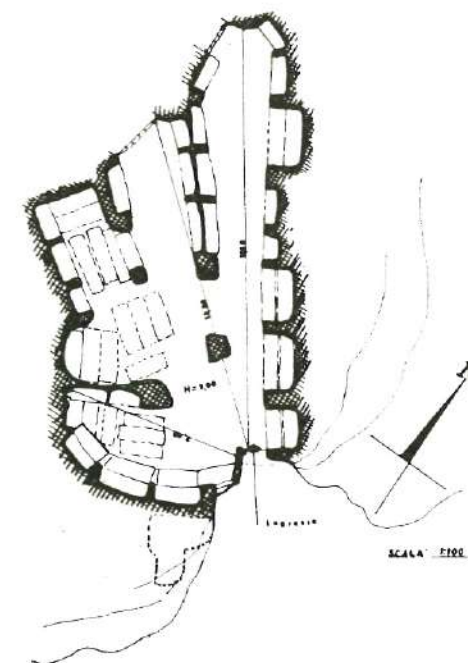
CAPPARELLI: planimetria dell'ipogeo n. 3.
